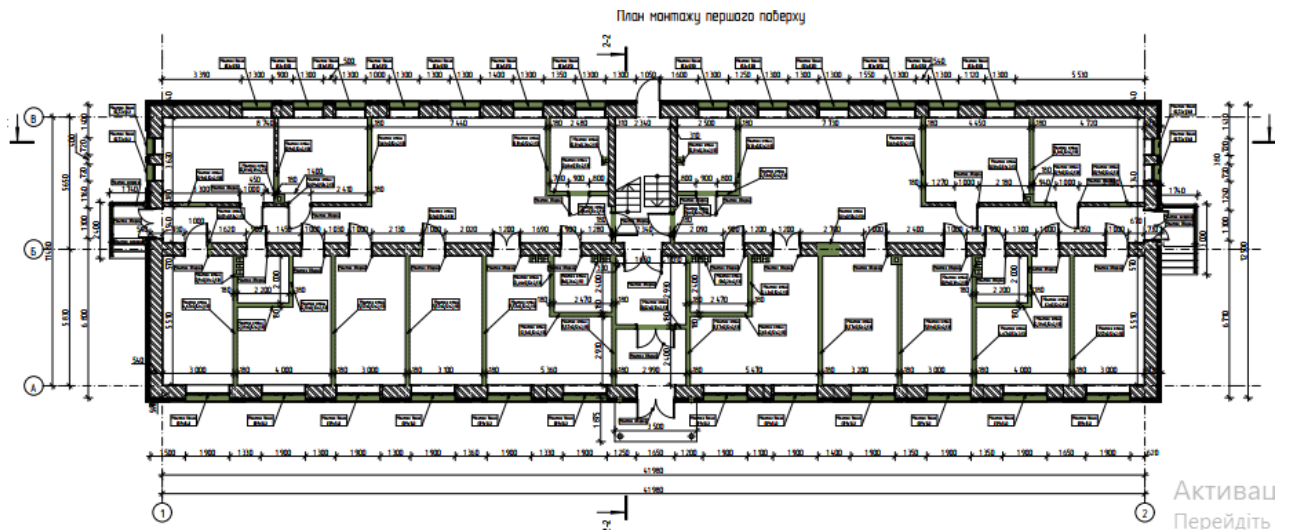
План перепланування кімнат 1-го поверху будівлі.
